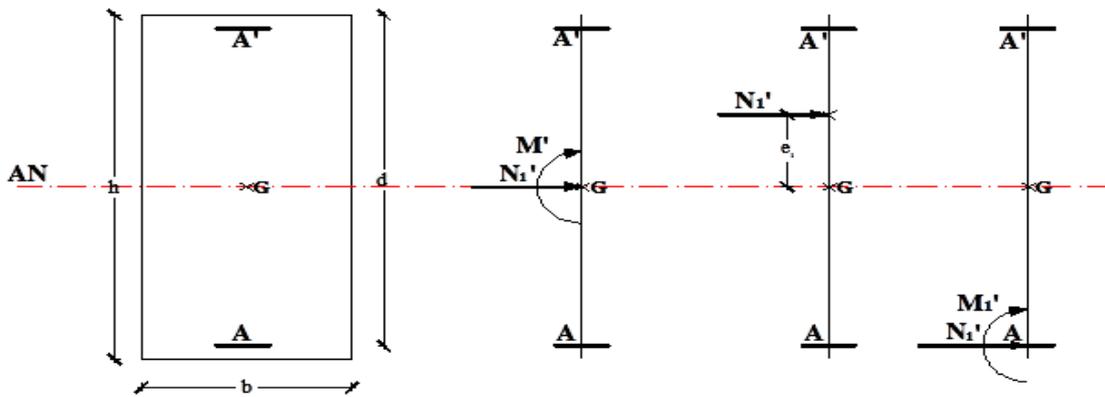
Position de N_1' , M_1' et M_1 sur la section transversale
